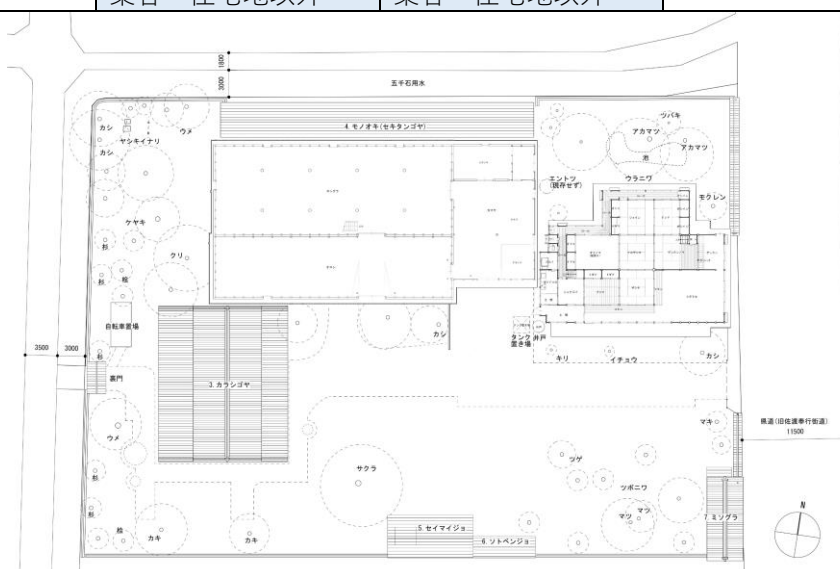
No.69とNo.70の配置図兼1階平面図¹²²
